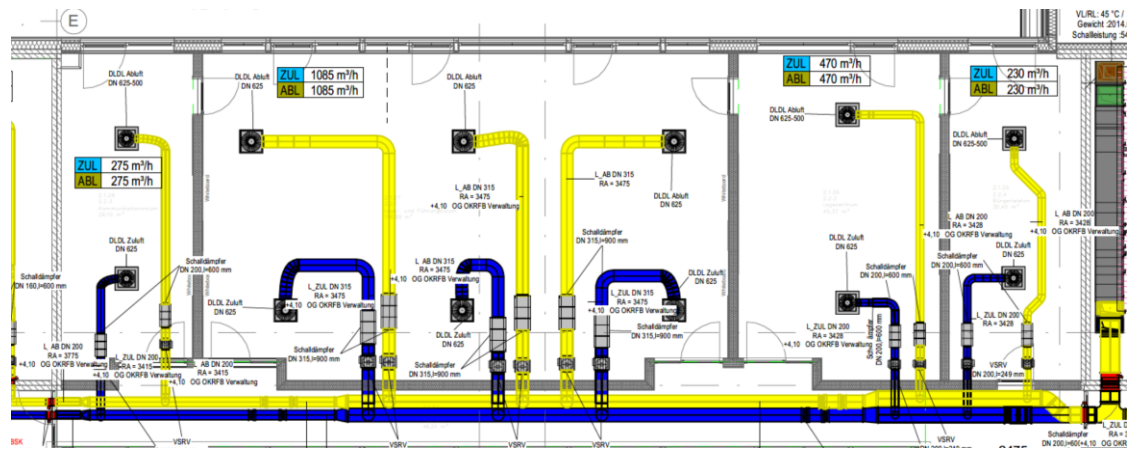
Grundrissausschnitt mit Lüftungsplanung Krisenstab
